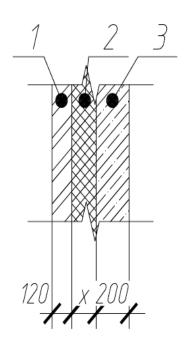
Конструкция наружной стены: 1 – Облицовочный слой из кирпича керамического пустотелого; 2 – негорючие теплоизоляционные плиты минераловатные из каменного волокна; 3 – кладка из кирпича
